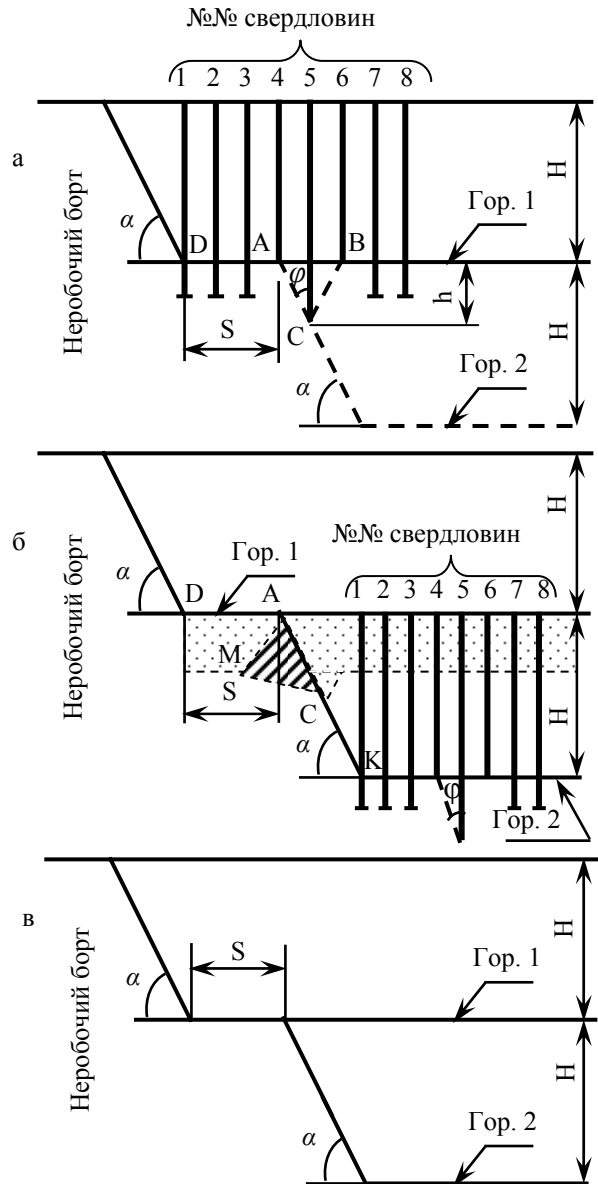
Нова схема розташування свердловин руйнування вибухом скельних порід в зоні неробочого борту кар'єру
